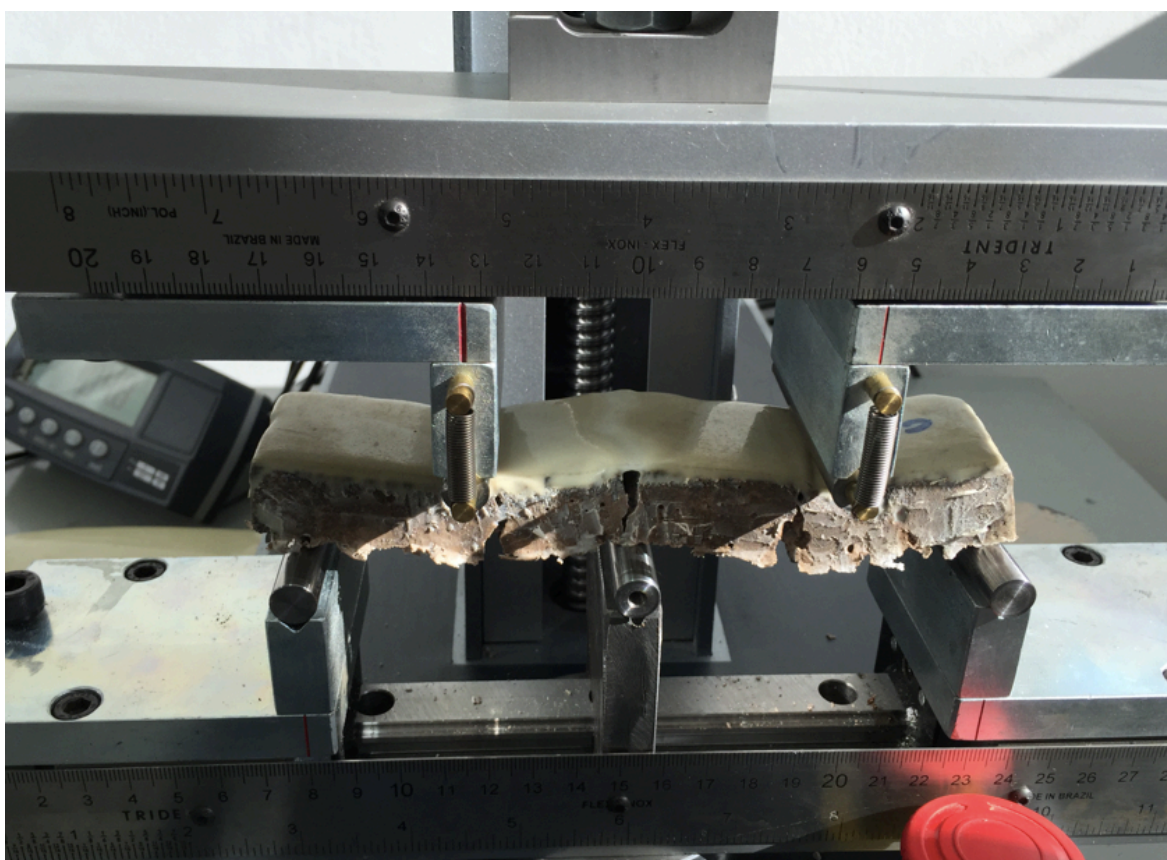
Ensaio de flexão no prisma de concreto.
